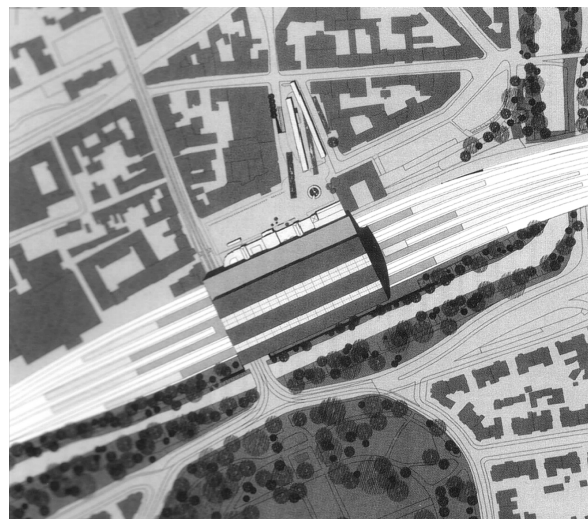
Lageplan des neuen Erfurter Hauptbahnhofes
